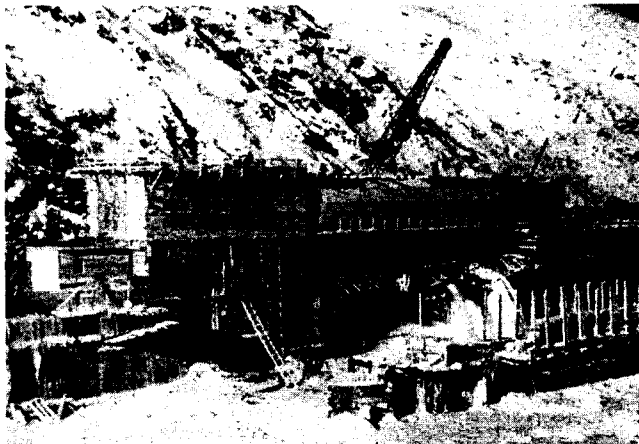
Тепляк для укладки бетона методом «термоса» и монтаж первого в гидростроительстве подвижного шатра на Бухтарминской ГЭС
